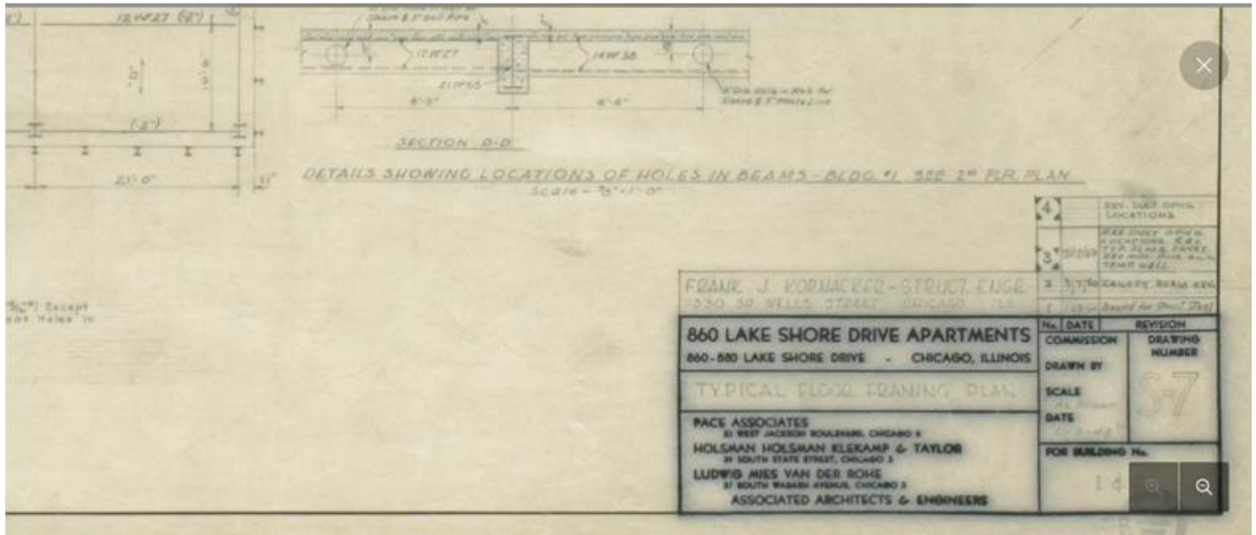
Detalhe de uma planta de um apartamento da Lake Shore Drive em que aparece o nome de Frank Kornacker.
